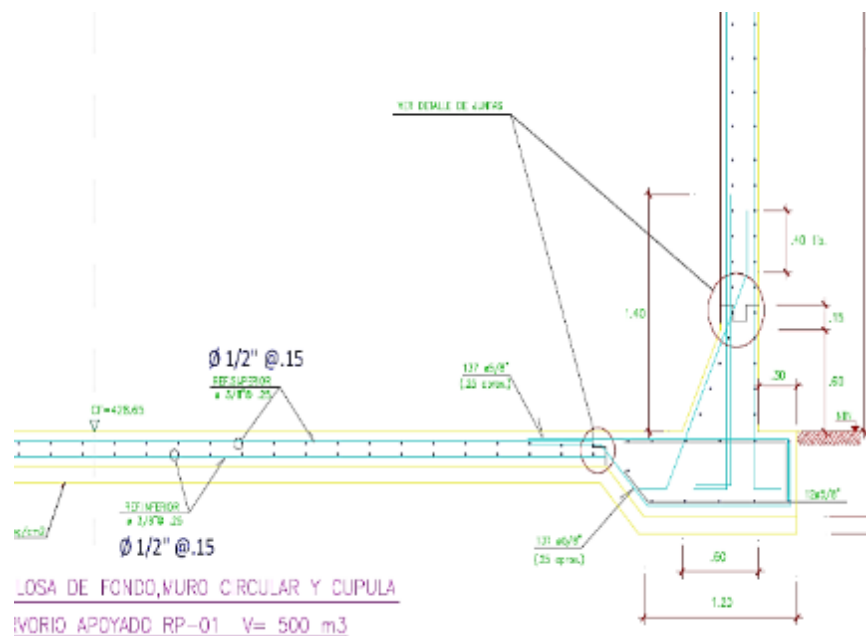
Acero instalado en losa de cimentación. Fuente: SAP2000
